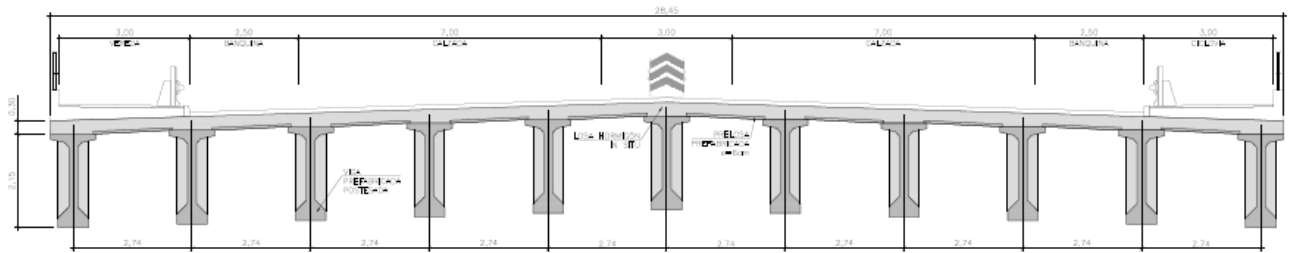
Sección tipo de tablero de vigas doble T para calzada doble.
